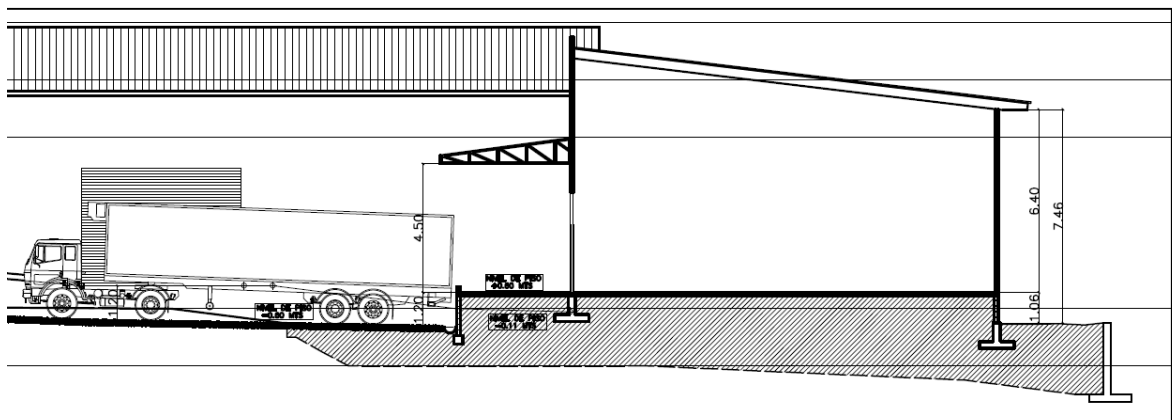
Vista lateral de las Galeras a Construir. Fuente: Planos del Proyecto.
